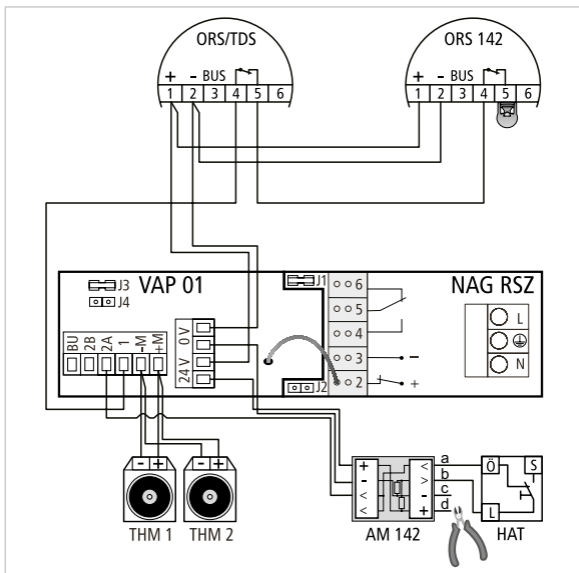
Anschluss mit 2 Feststellvorrichtungen, Handauslösetaster und externen Brandmeldern
